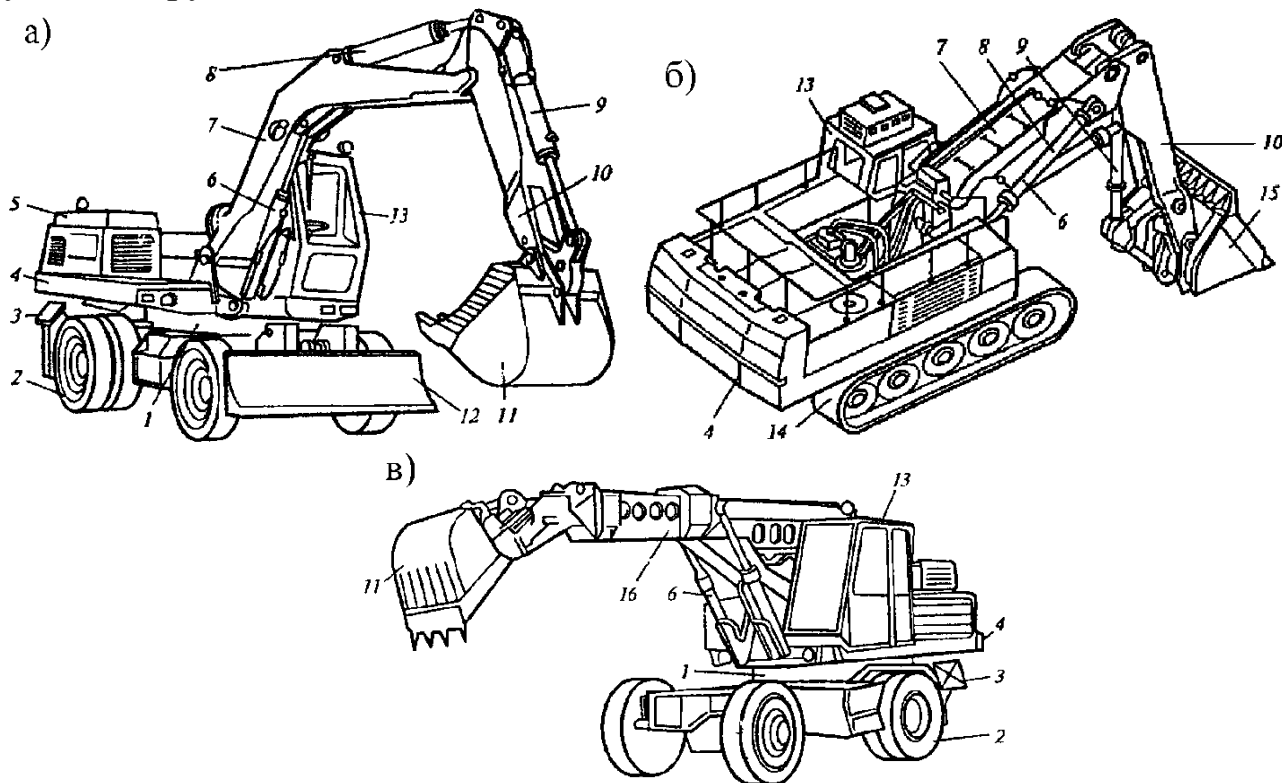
Одноковшовые гидравлические полноповоротные экскаваторы с жесткой подвеской рабочего оборудования: а) экскаватор с оборудованием обратная лопата;
